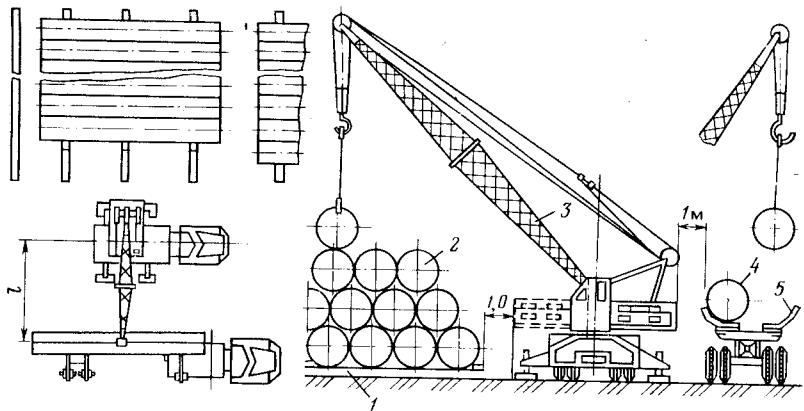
Схема погрузки труб из штабеля на транспортные средства:
